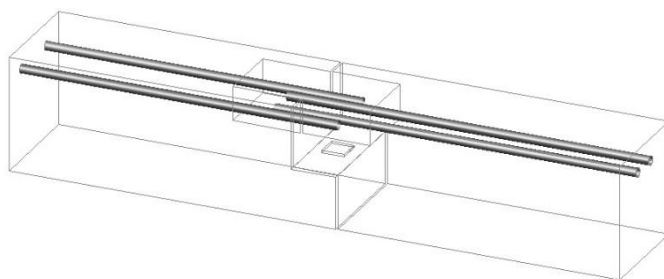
Ligação Viga – Viga por juntas em dente e varões soldados
